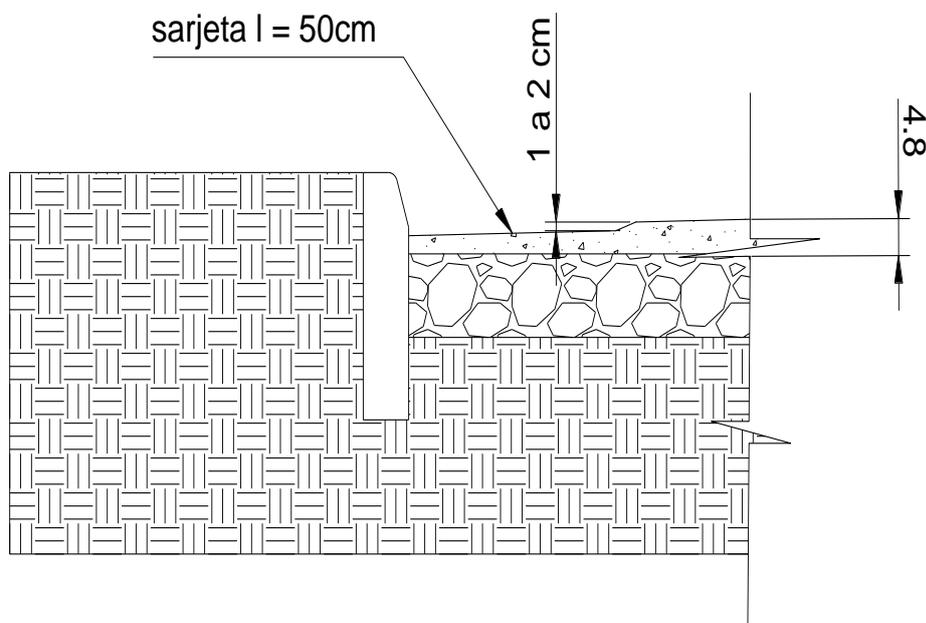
Detalhe do desnível na pavimentação para a execução da sarjeta.
